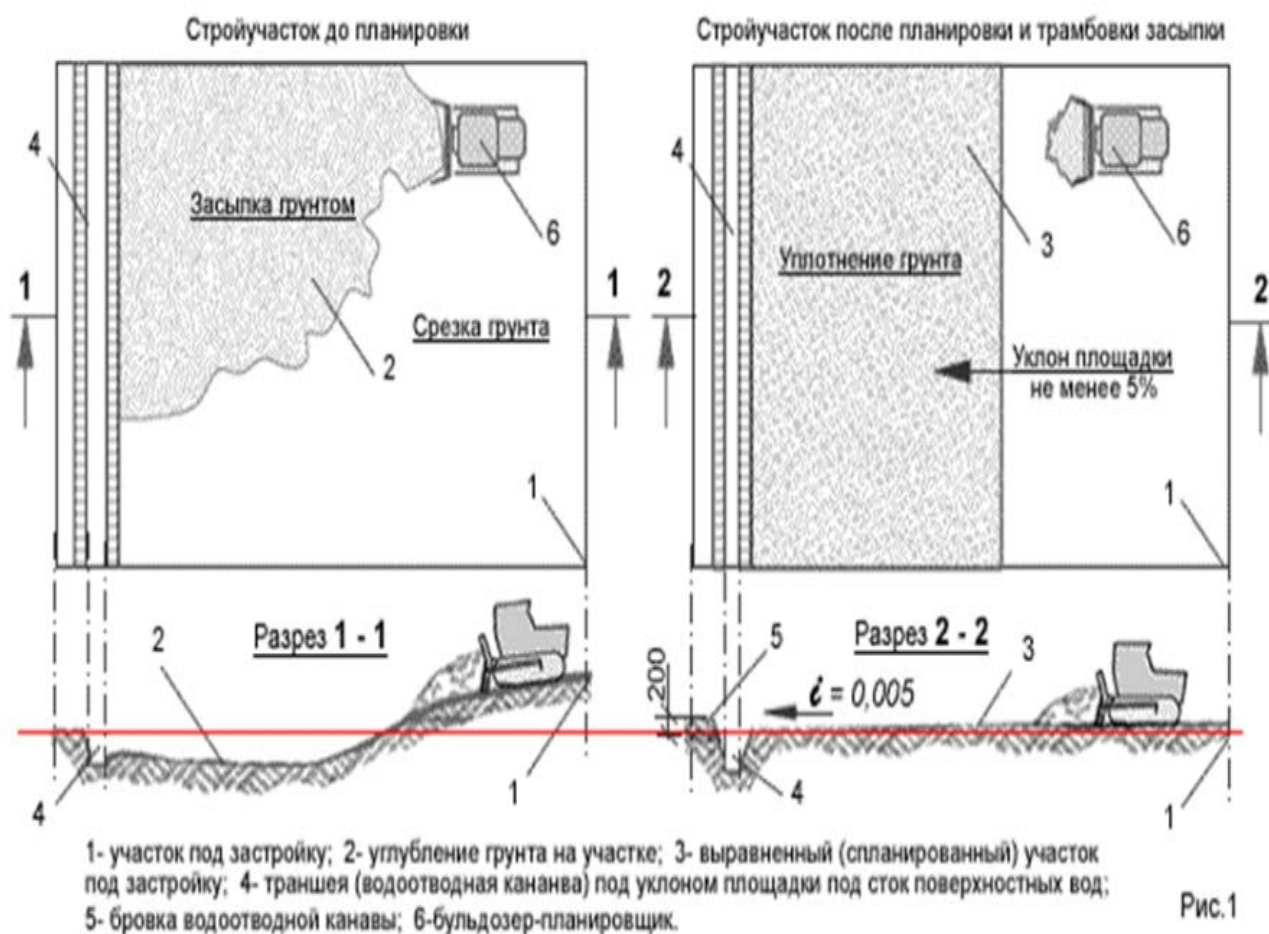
Схема планировки бульдозером строительной площадки
